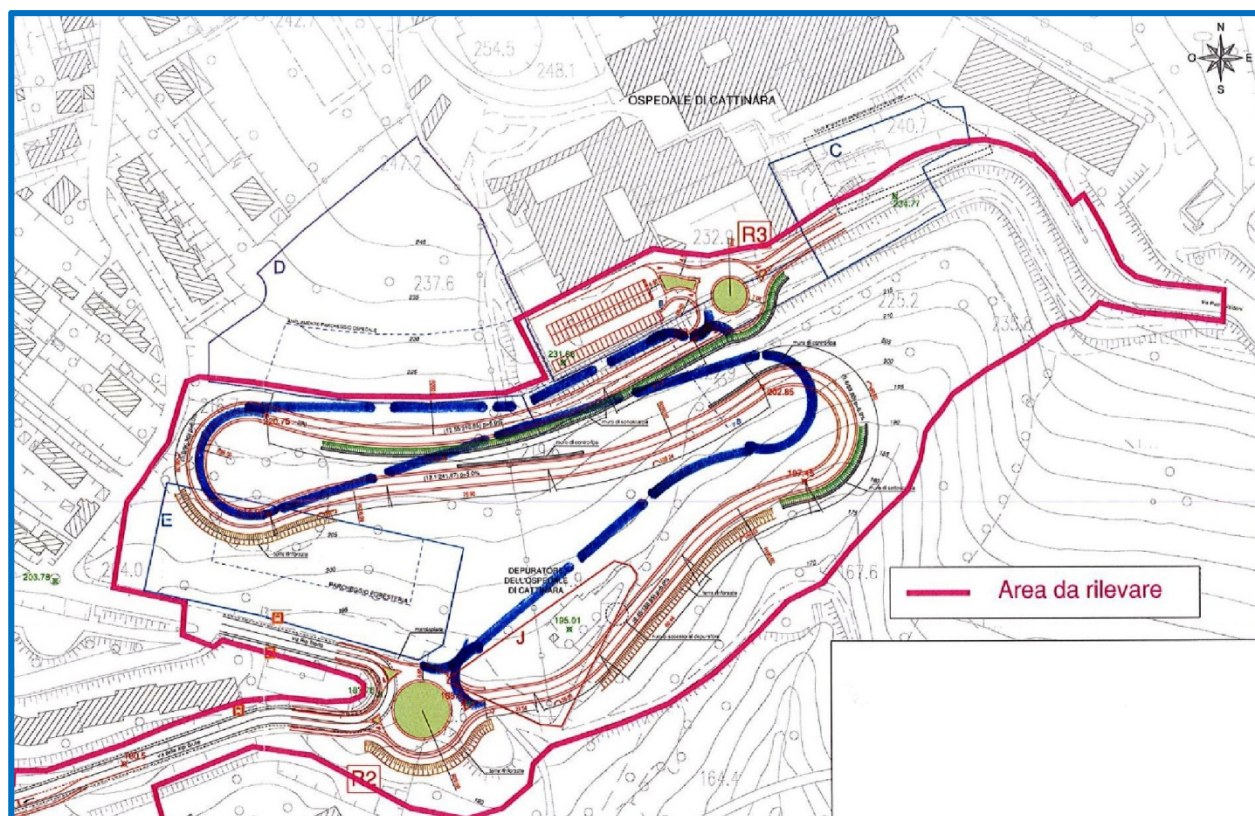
Soluzione del tracciato, proposta dal progettista ing. Novarin, alternativa rispetto a quella iniziale di Fig. 1.2.
